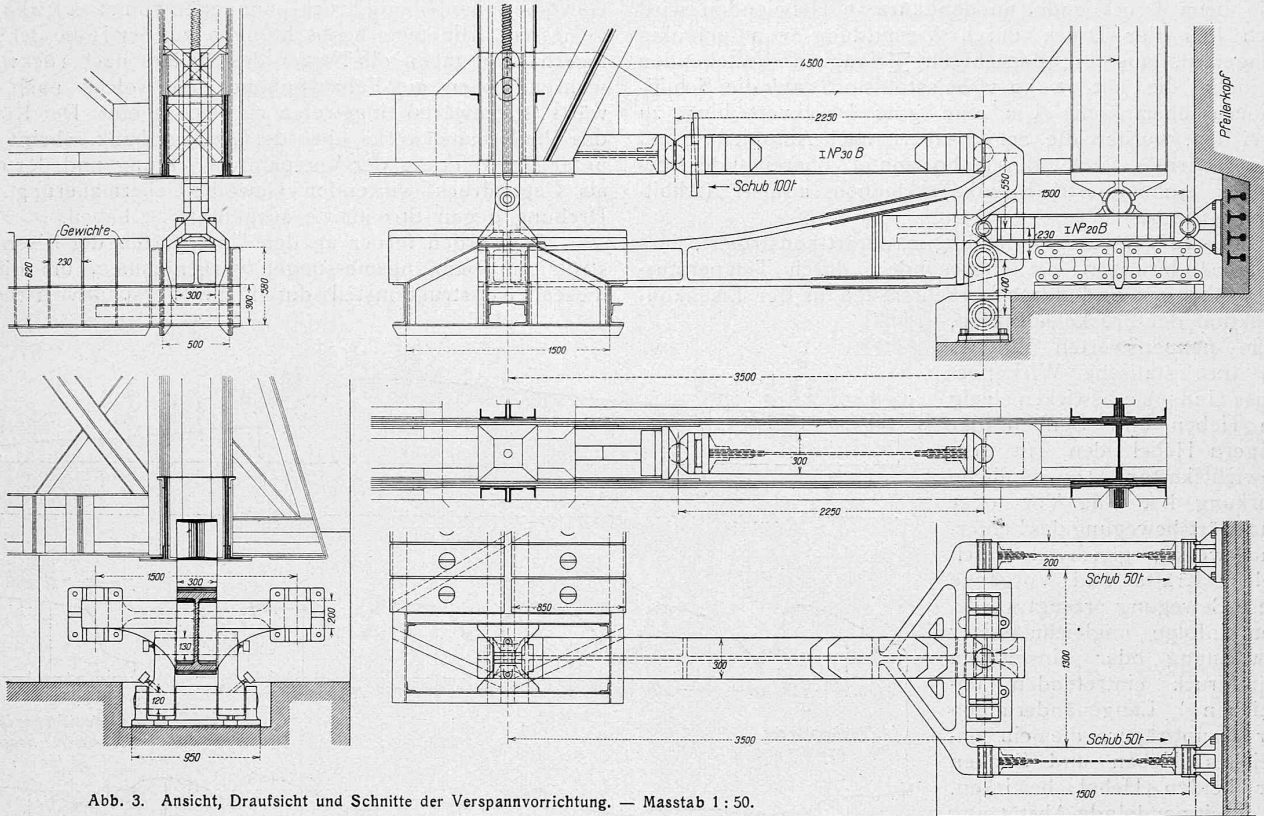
Ansicht, Draufsicht und Schnitte der Verspannvorrichtung. — Masstab 1 : 50.
